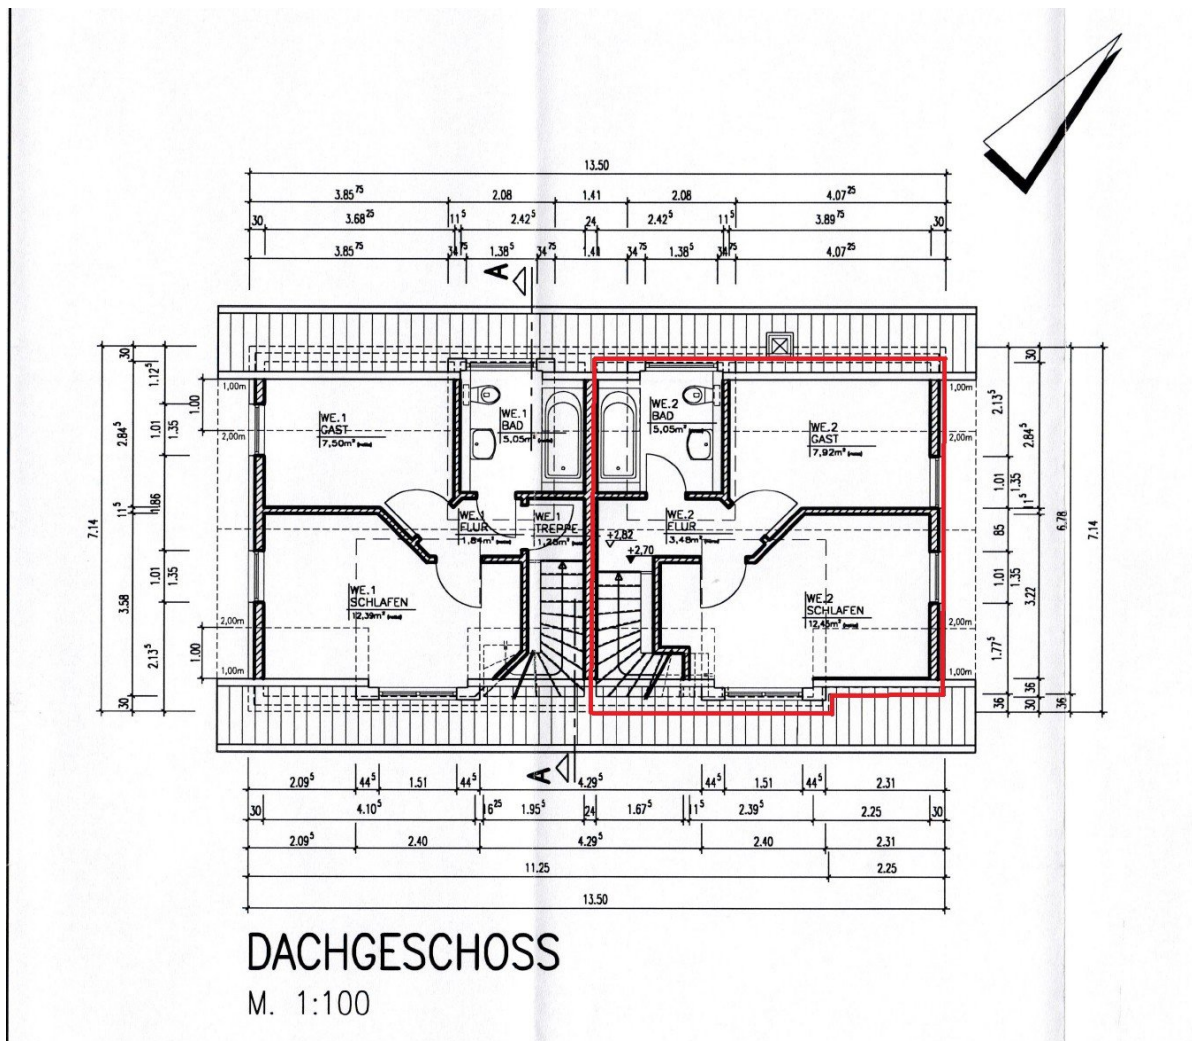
Grundriss Dachgeschoss (Abgeschlossenheitspläne)
